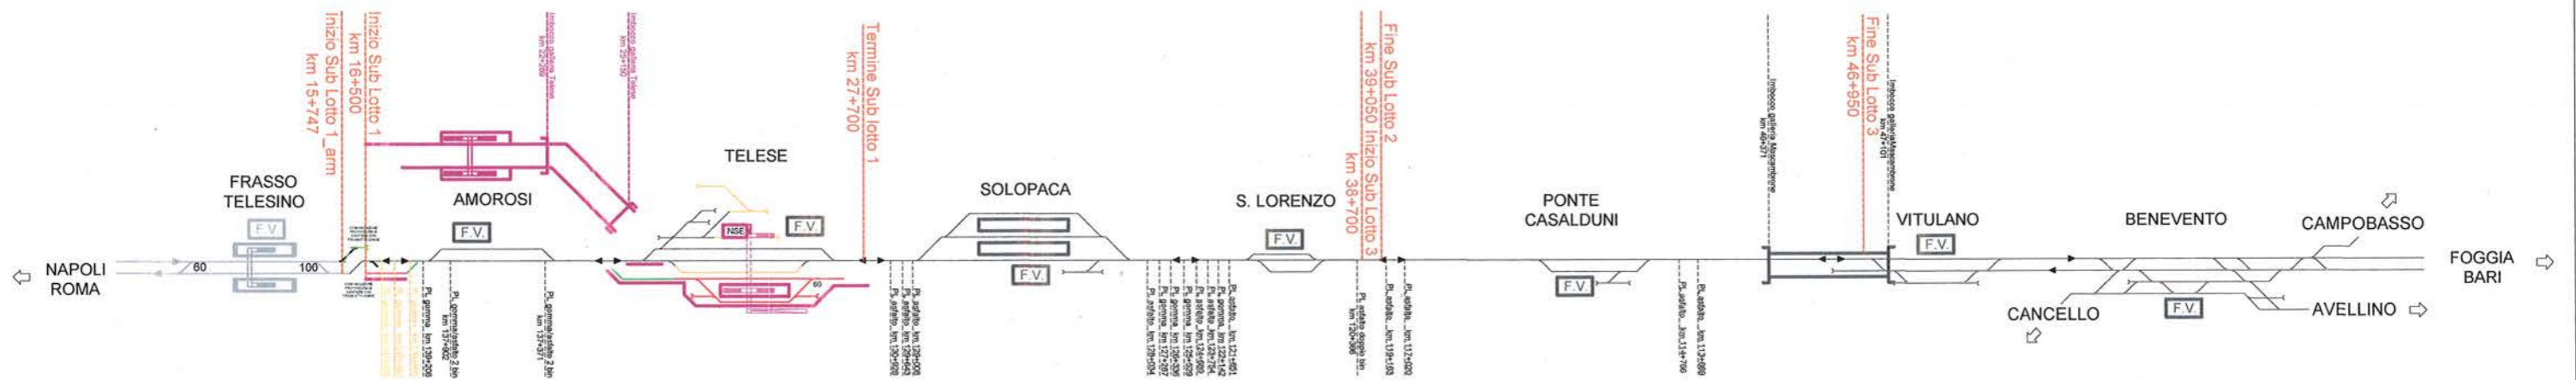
Schematico della Situazione finale di progetto – Sub Lotto 3
